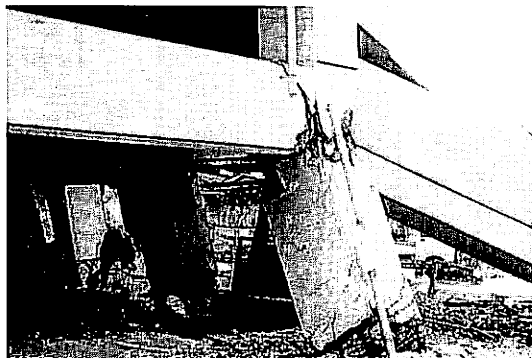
写真-6の1階（ピロティ）柱の曲げ破壊
